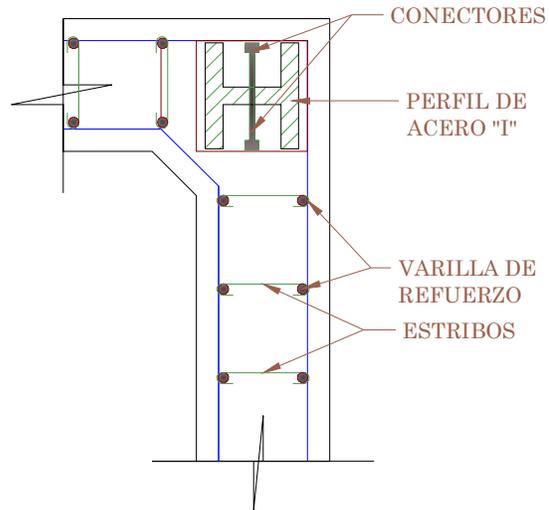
Detalle de una sección de muro empleando acero estructural, un perfil I, para dar mayor resistencia a la estructura.
